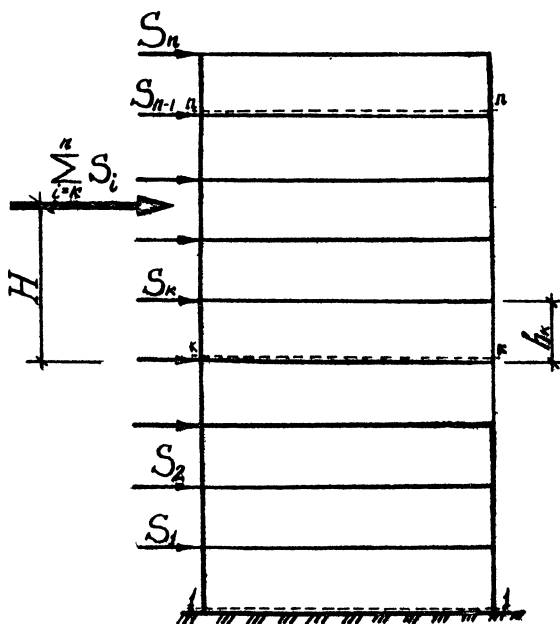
Равнодействующая расчетных сейсмических сил выше расчетного горизонтального сечения стены здания
